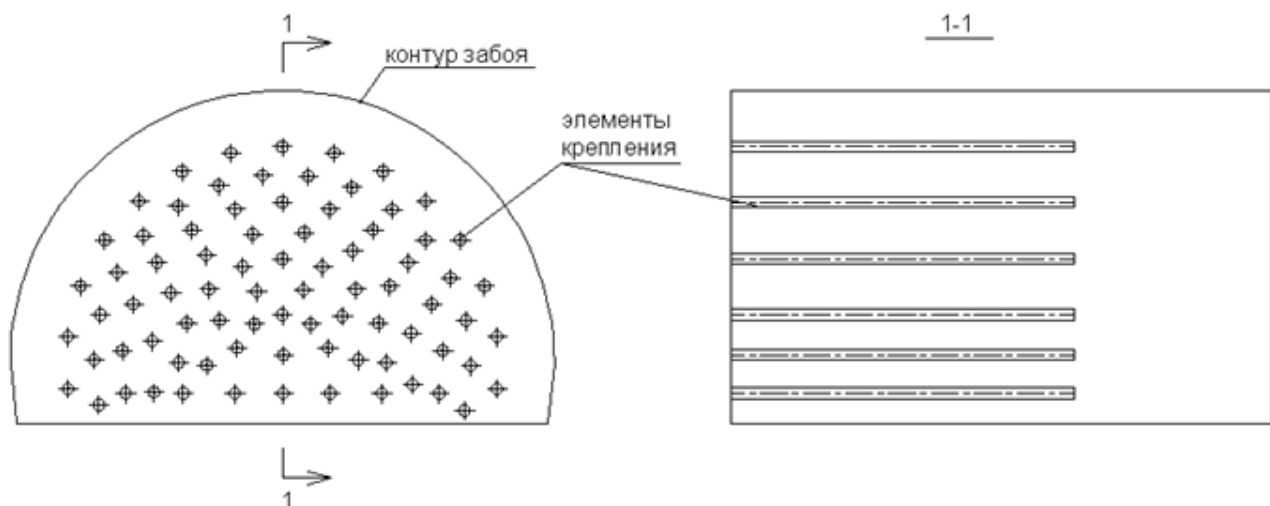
Опережающее крепление забоя по трассе проходки при помощи армирующих элементов из АНК-С
